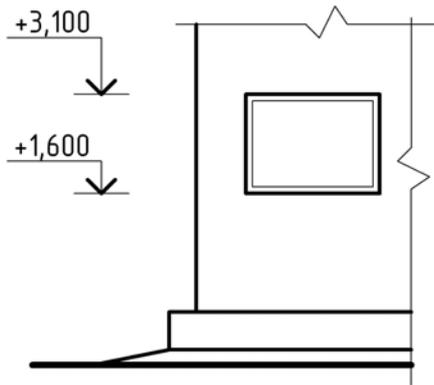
Нанесение знака высотной отметки на чертеж фасада здания
